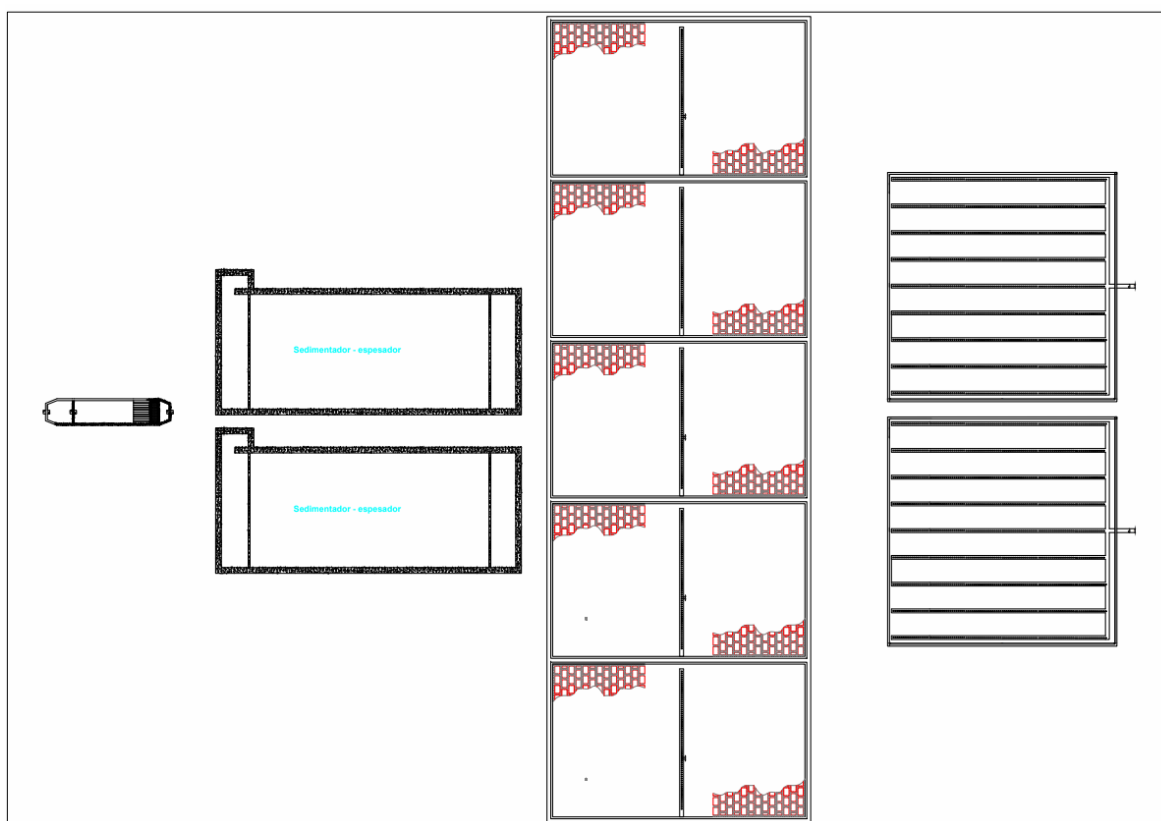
Diseño de configuración de planta piloto de lodos fecales (Maldonado & Ortiz, 2021).
